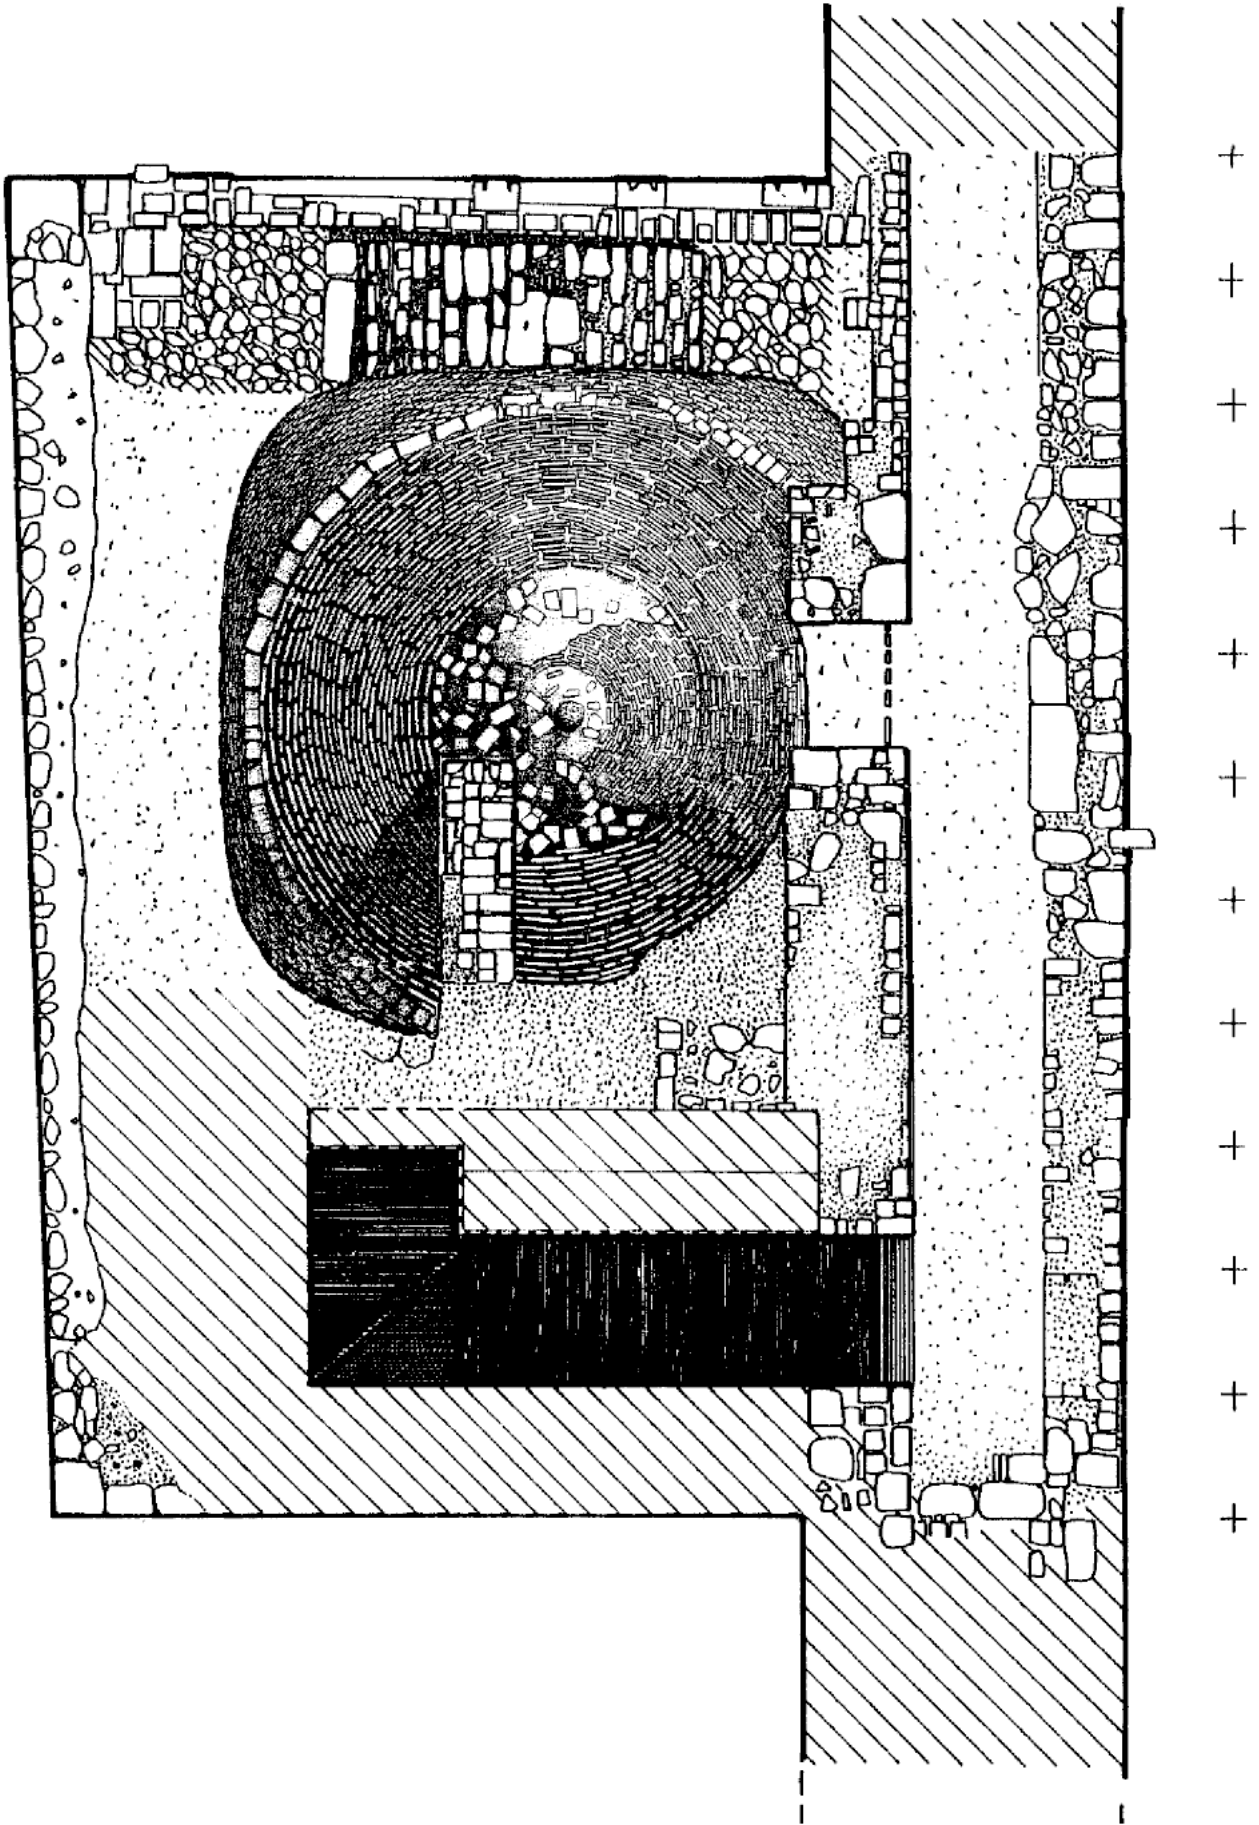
Puerta de Sevilla. Planta de la coronación de la puerta-torre.
